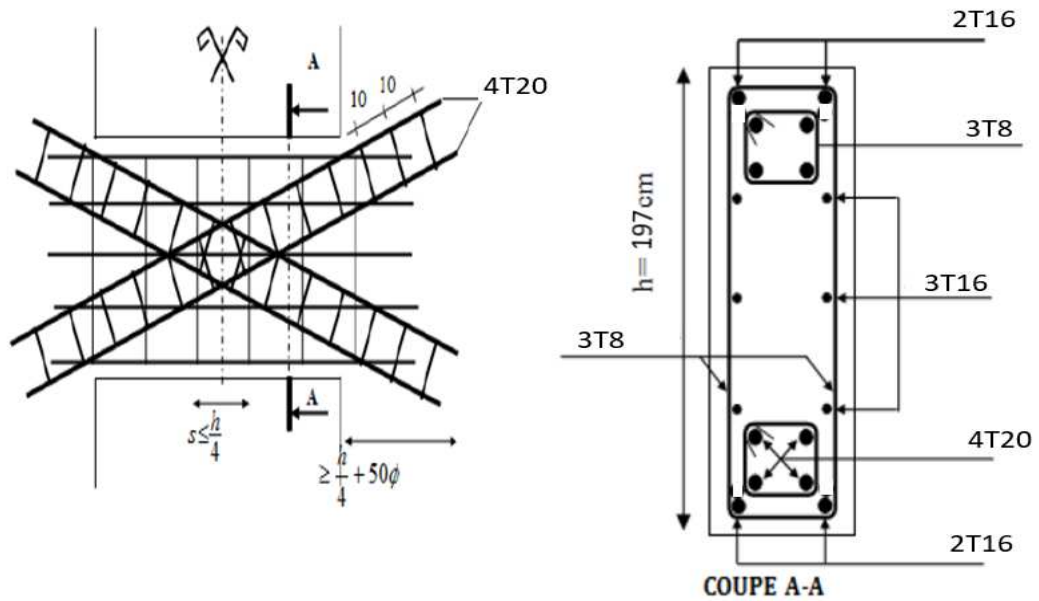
Schéma de ferrailage du linteau(RDC).
